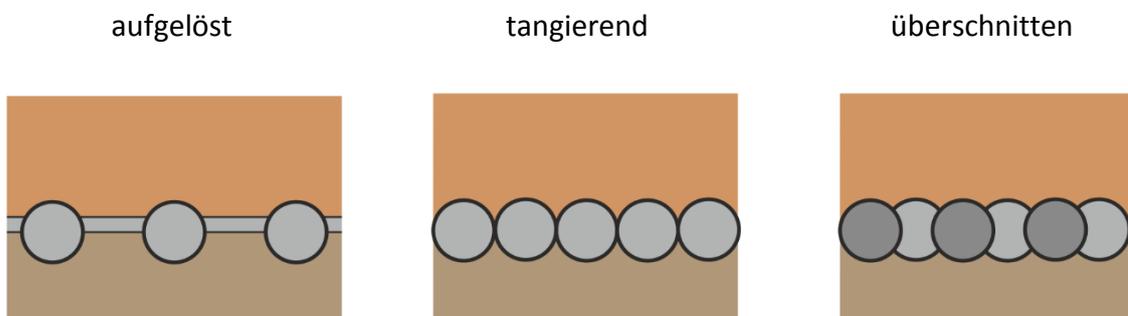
Grundriss unterschiedlicher Pfahlwandtypen
